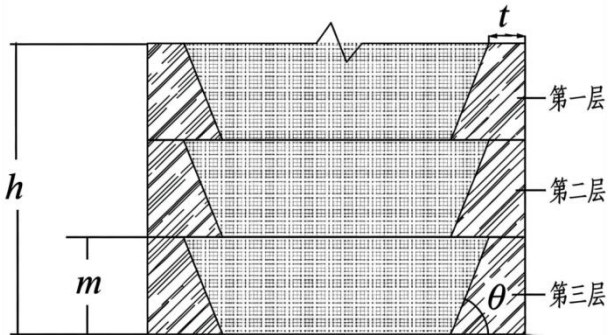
桥梁大体积混凝土分层推移浇筑施工示意图
